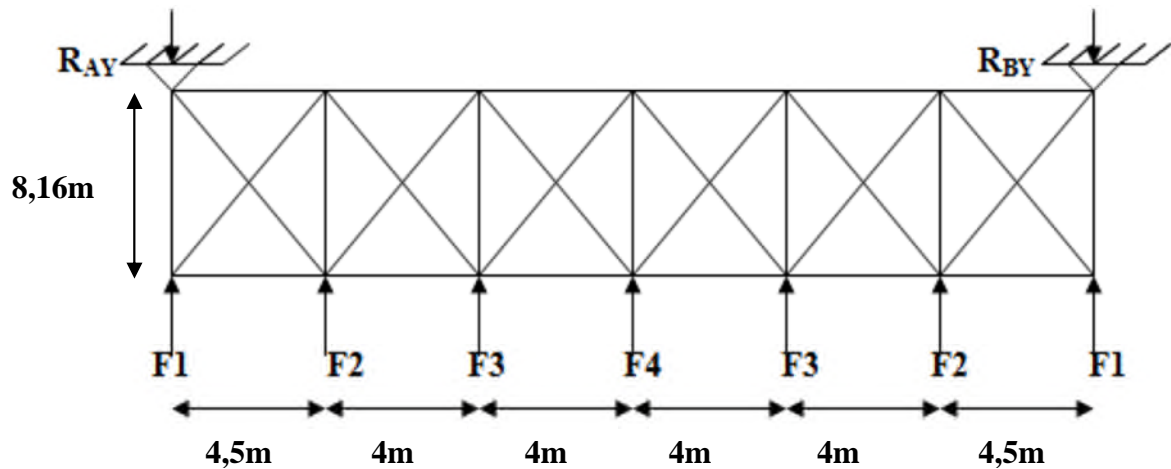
Schéma statique de la poutre au vent en pignon.
